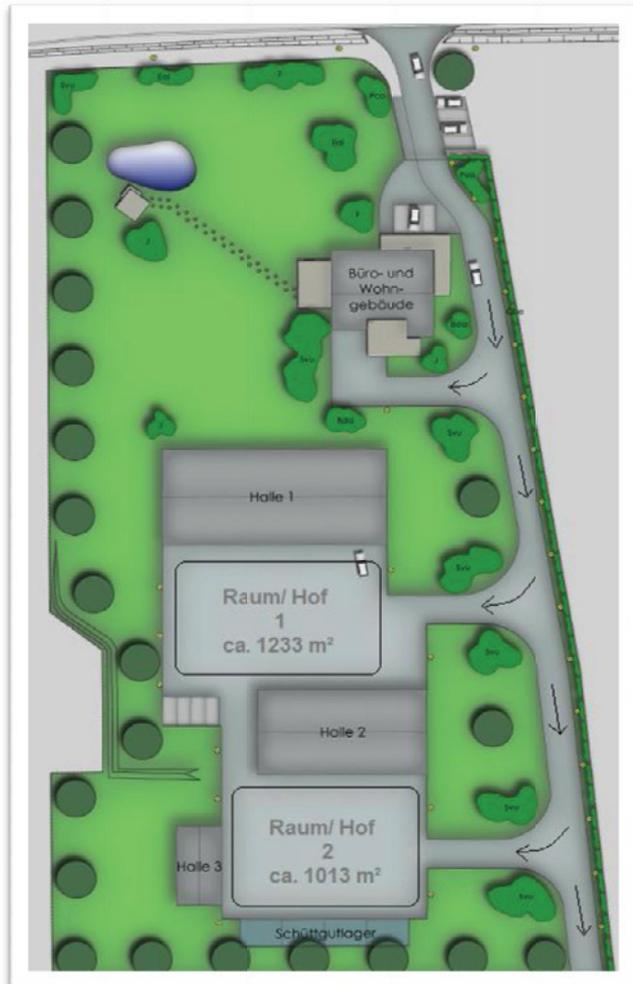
geplante Räume/Höfe und Straßenführung Entwurf 2
